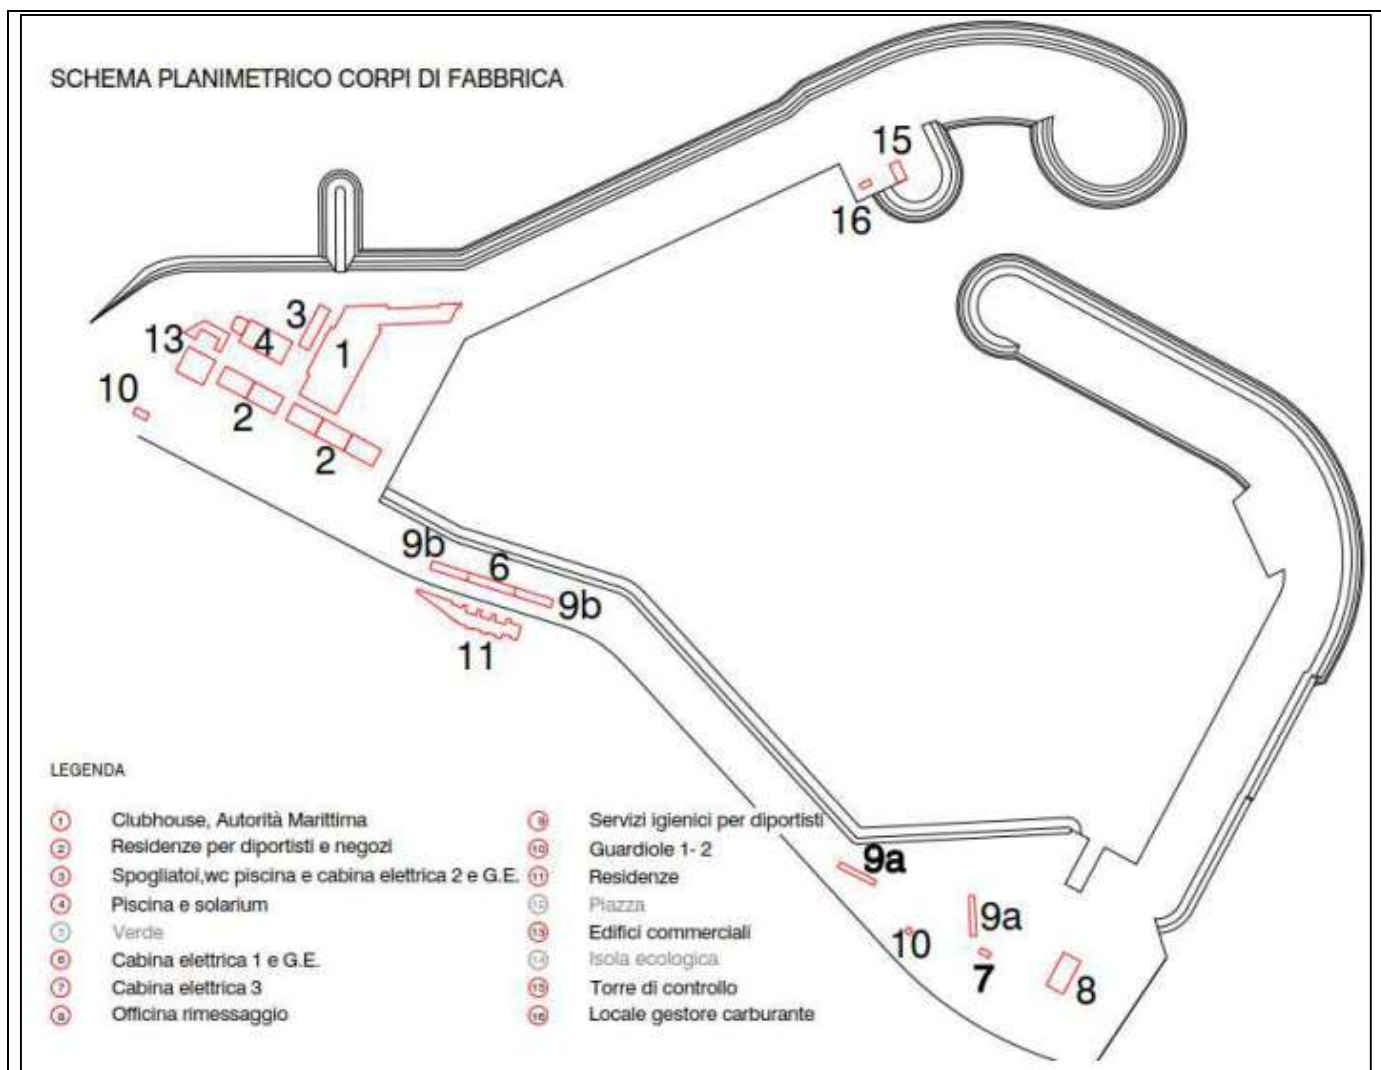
Schema planimetrico dei corpi di fabbrica previsti.
